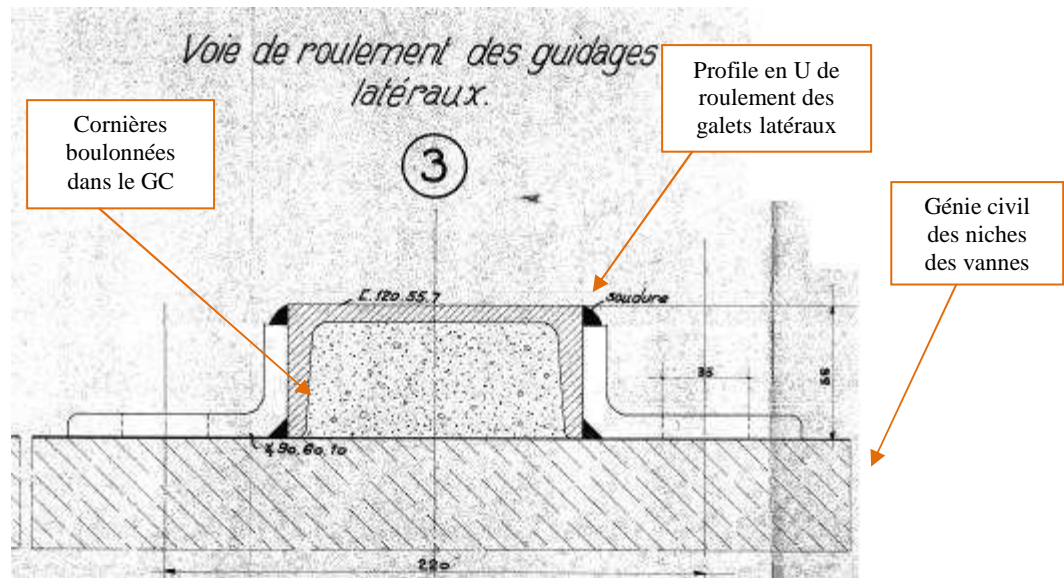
Coupe de la voie de roulement des galets de guidage latéral
